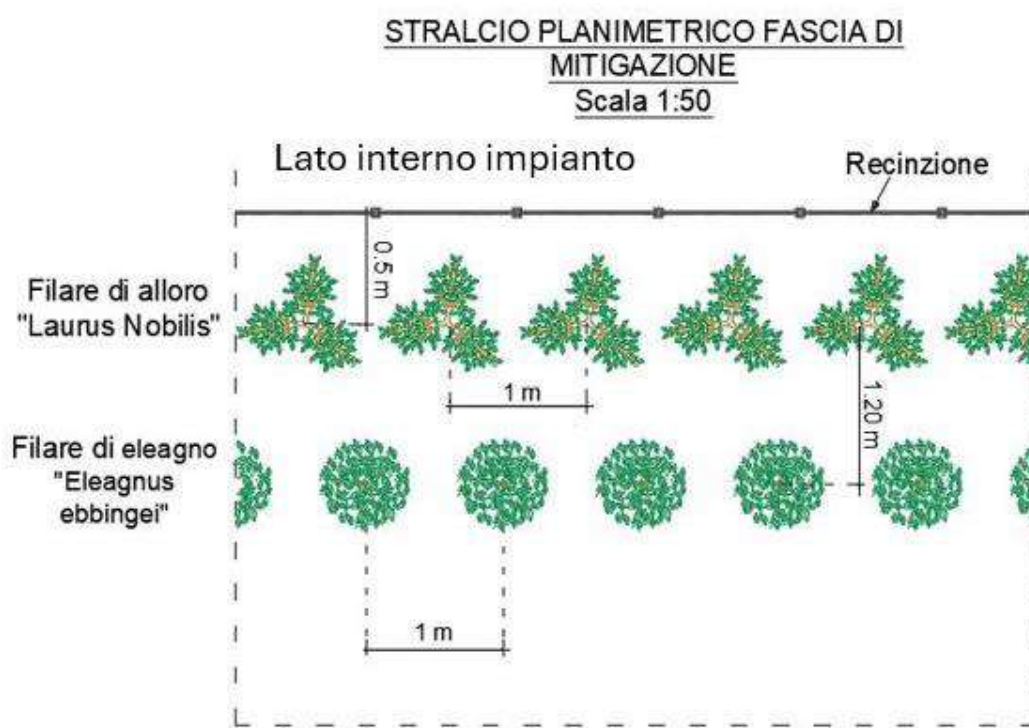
Stralcio planimetrico fascia di mitigazione perimetrale.
